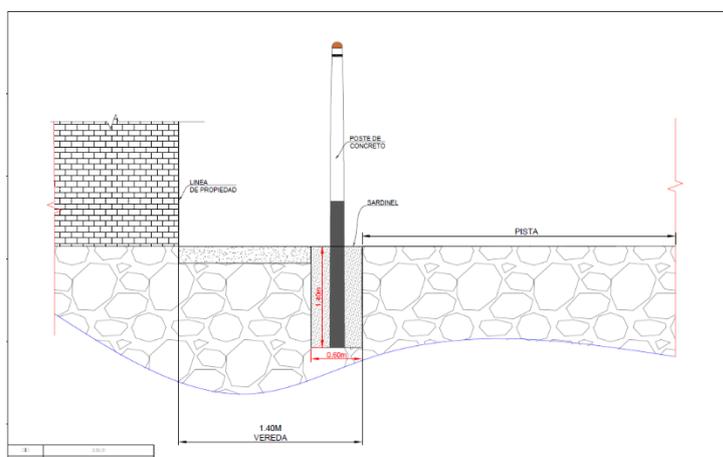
Plano de poste proyectado para el tendido aéreo de este proyecto
